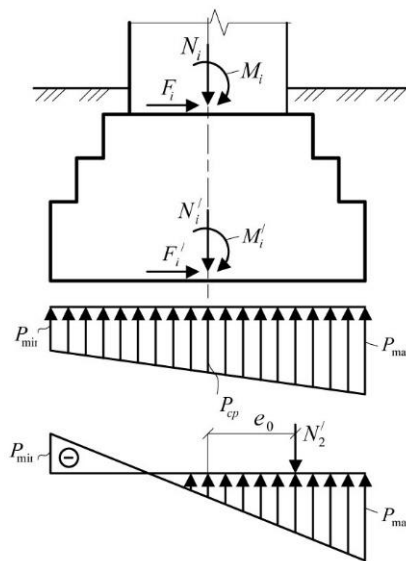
Епюри напружень під підос Basis фундаменту
